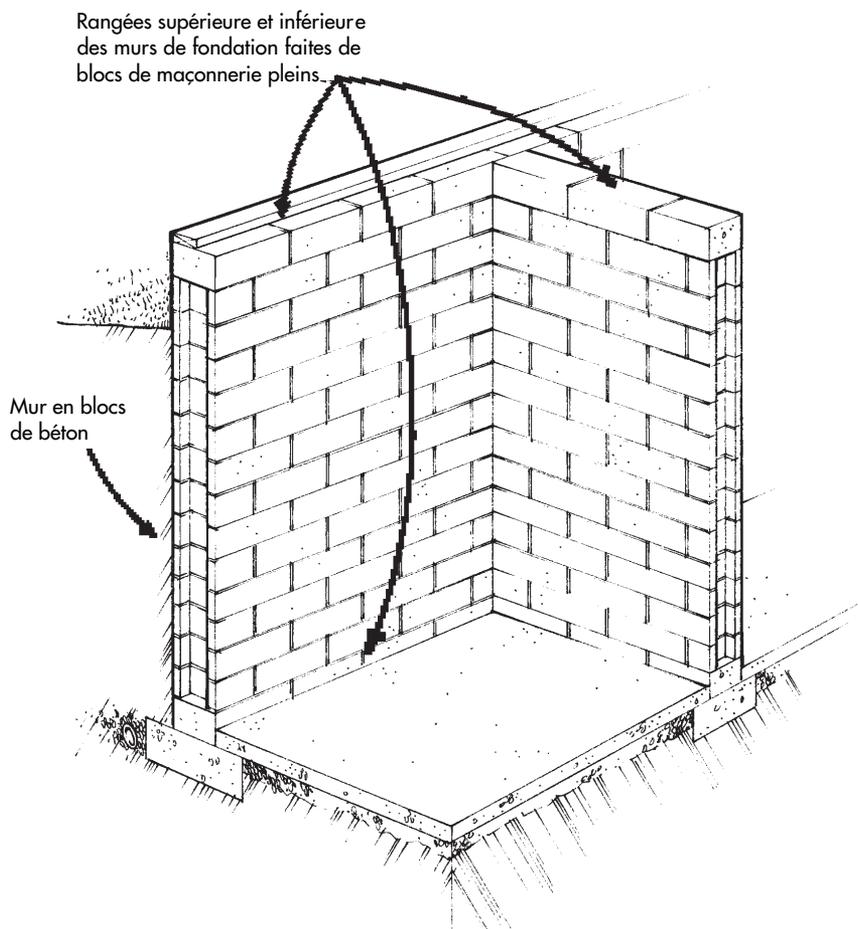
Élimination des cavités au haut et au bas des nouveaux murs de fondation en blocs de béton.
